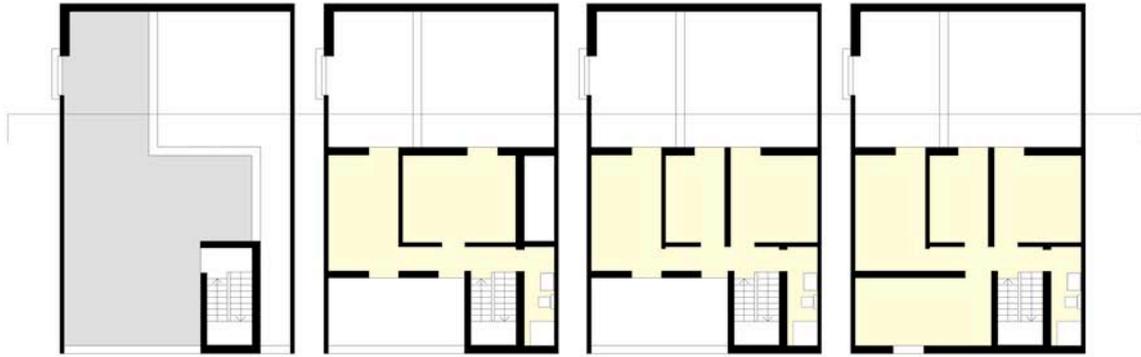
(izquierda): En esta tipología de vivienda (Tipología A) la planta baja dispone de un patio de 20 m² aprox. orientado hacia la calle que permite la iluminación natural de todas las estancias y sirve de acceso a la vivienda. La flexibilidad de su planta alta permite la construcción de hasta 4 habitaciones adicionales (T2, T3, T4 y T5), que sumadas a la habitación de la planta baja, configura una vivienda de 5 habitaciones (120 m² aproximadamente). El área mínima de la vivienda es de 60 m².
